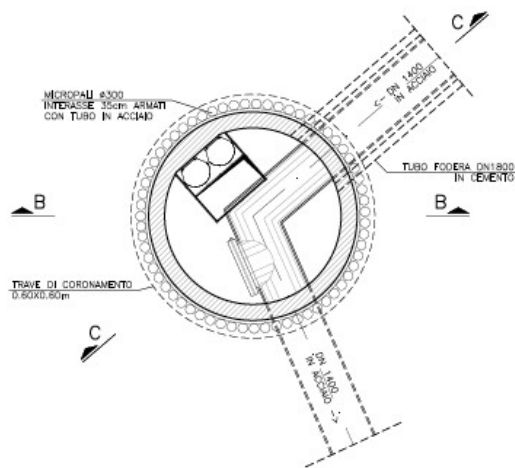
Pianta e sezione del Pozzo Pineta Sacchetti
